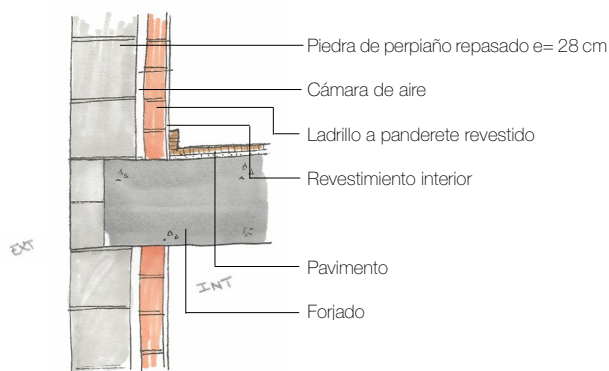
Sección de encuentro forjado con cerramiento (autoría propia).
